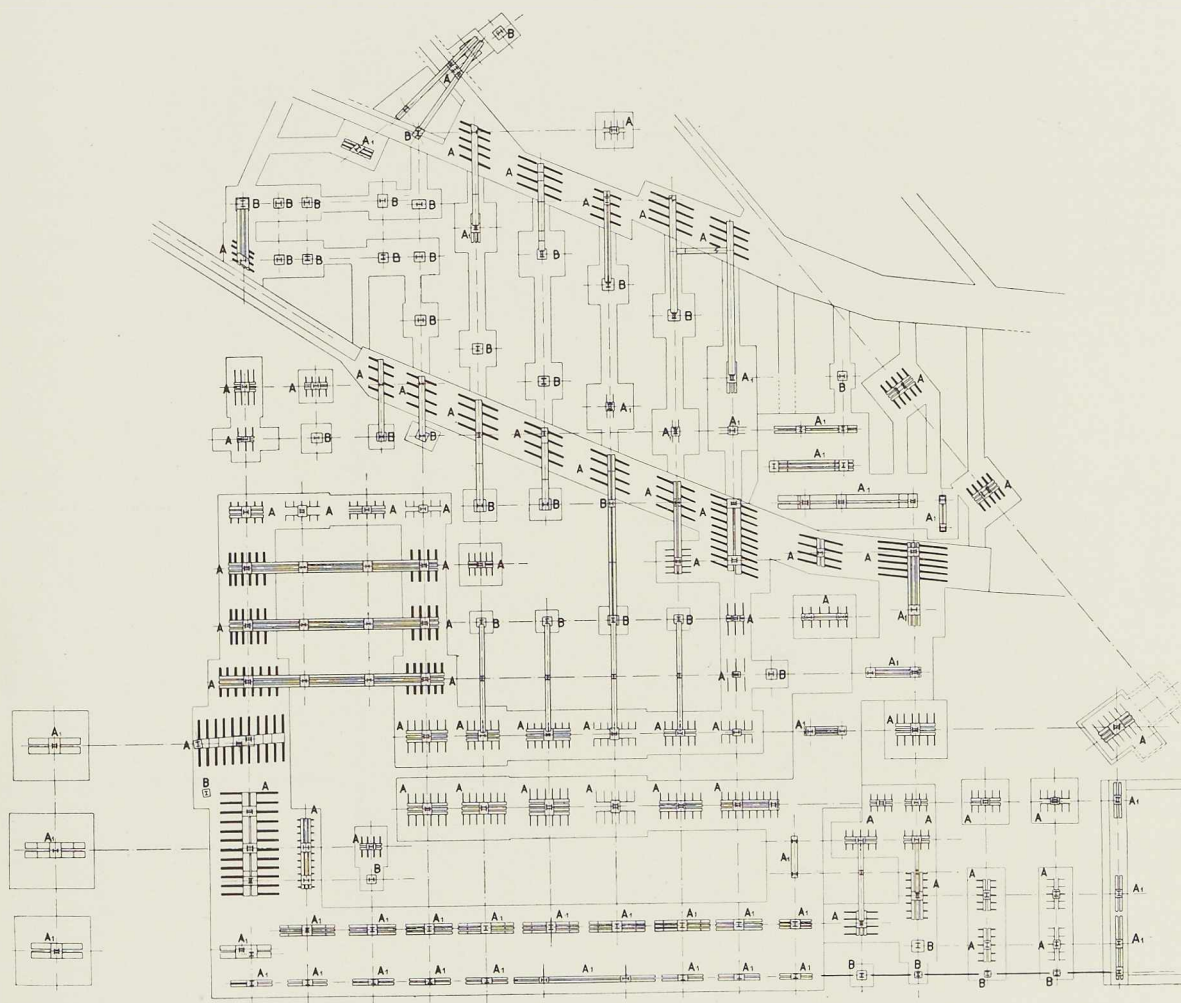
Plan des fondations à grillages de poutrelles du Queen's Hotel à Leeds (Angleterre).
